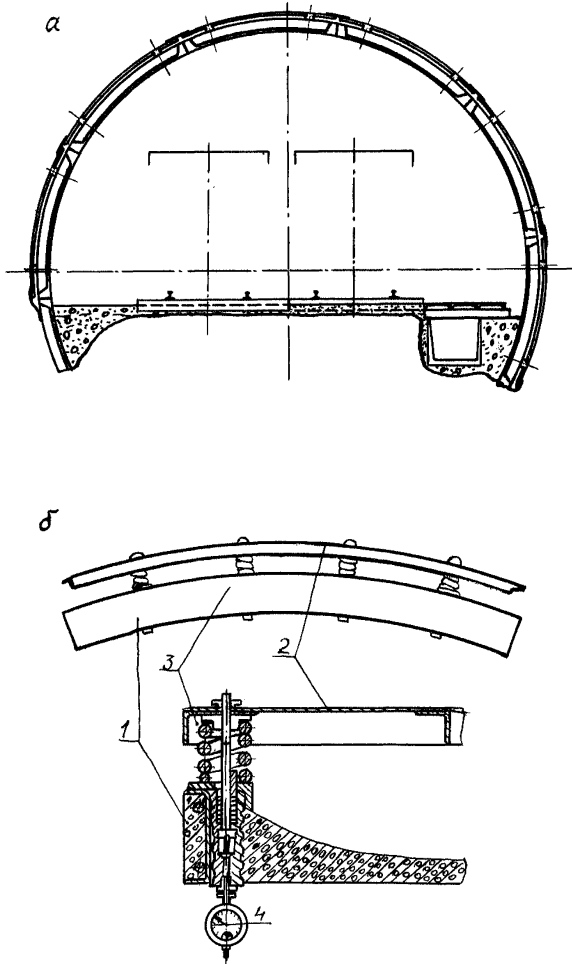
Динамометрическая крепь для измерений нагрузок на сборные железобетонные тубинговые крепи:
